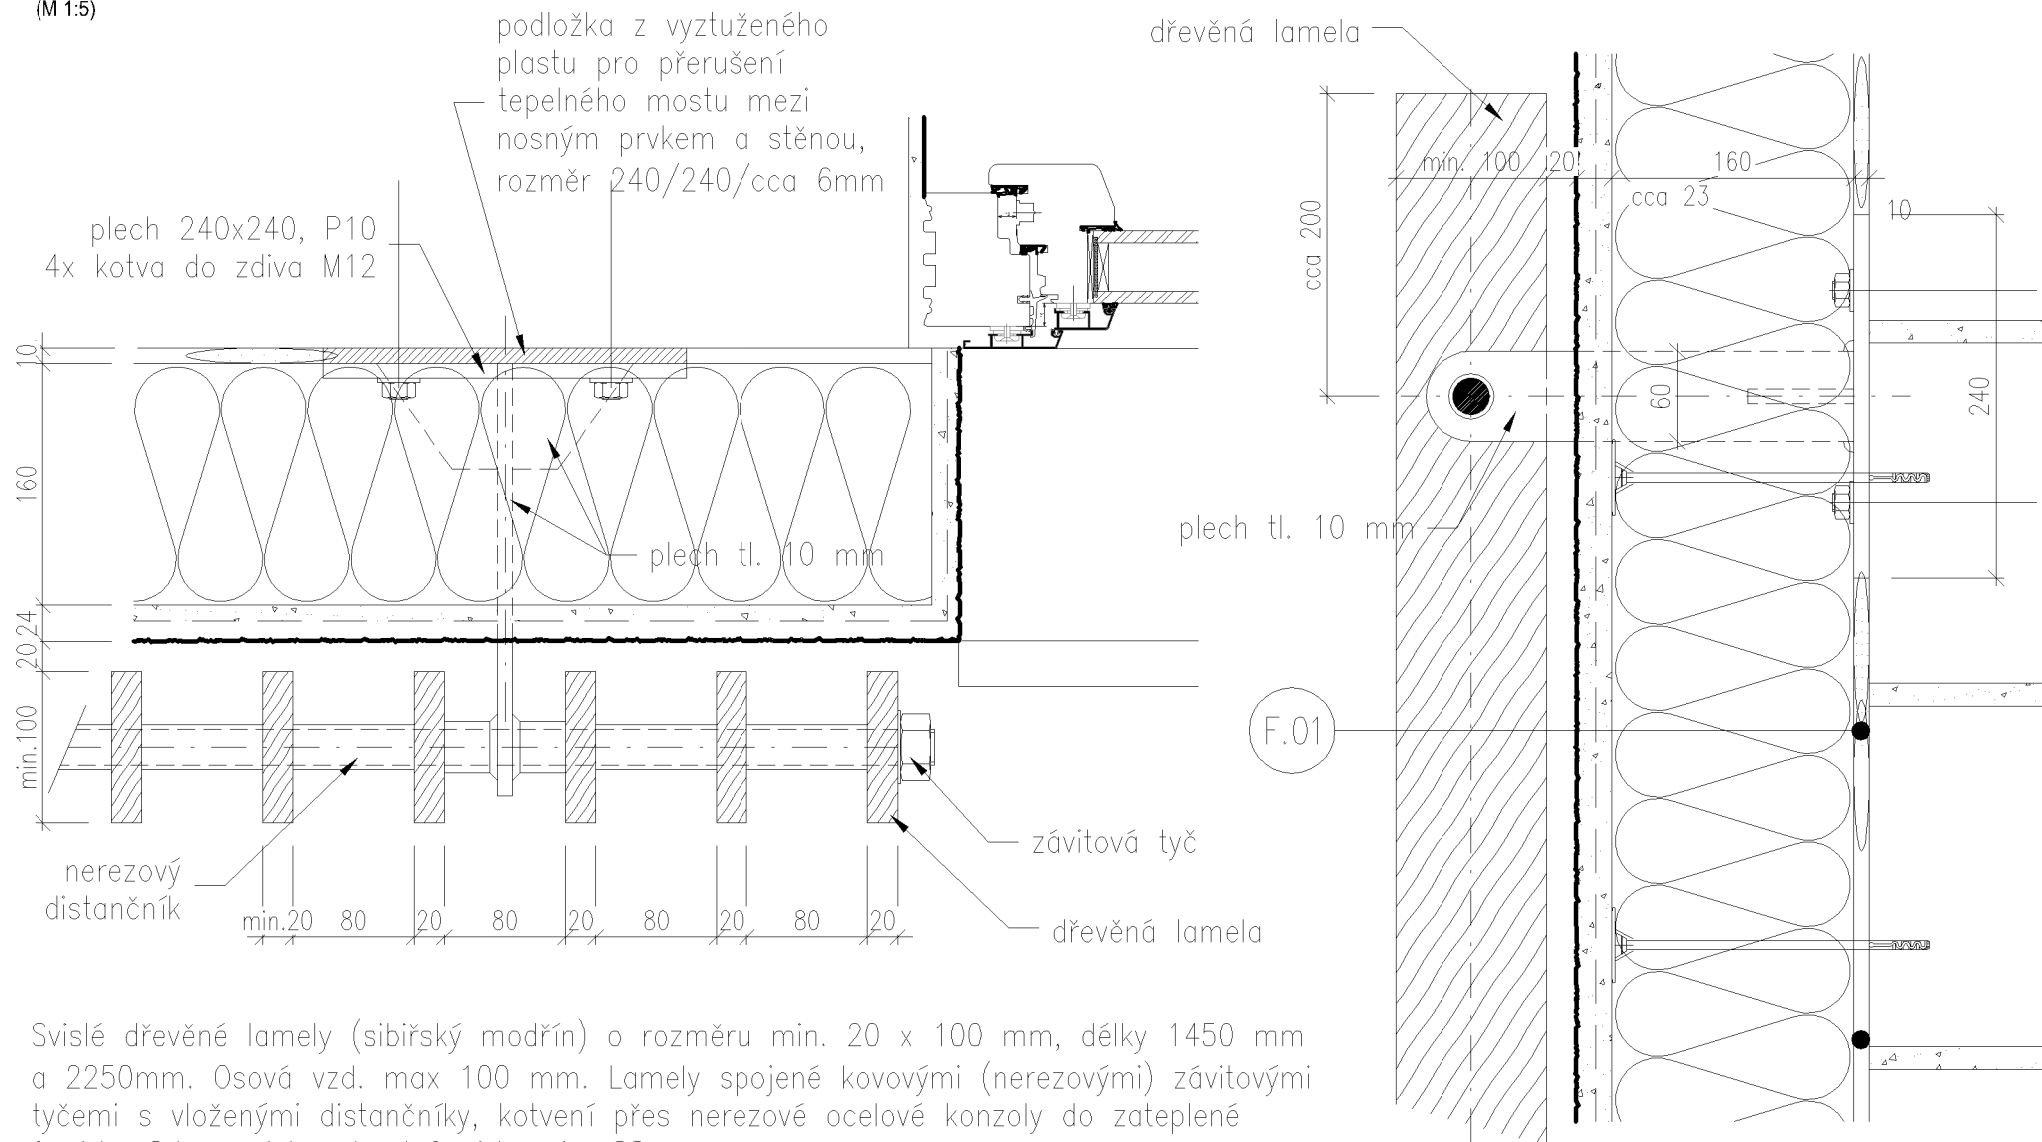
konstrukční řešení dřevěného oplocení mezi p.č. 951 a p.č. 973
